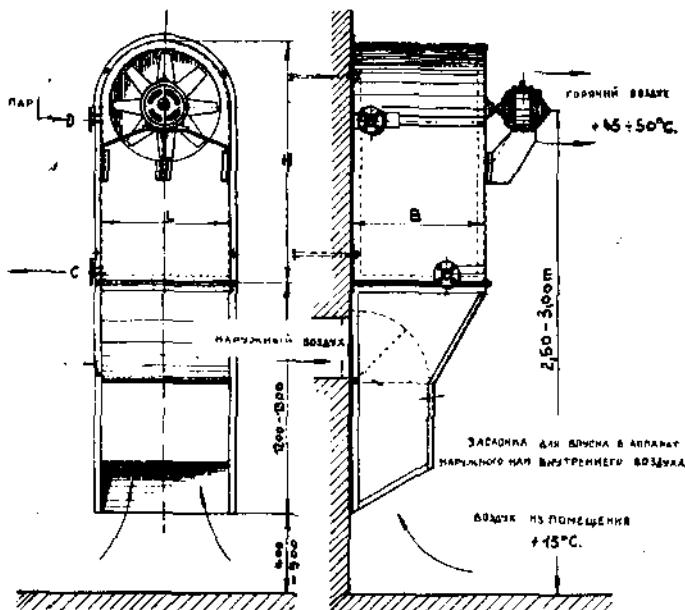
Местный воздухонагревательный прибор для укрепления на стену или колонну.
